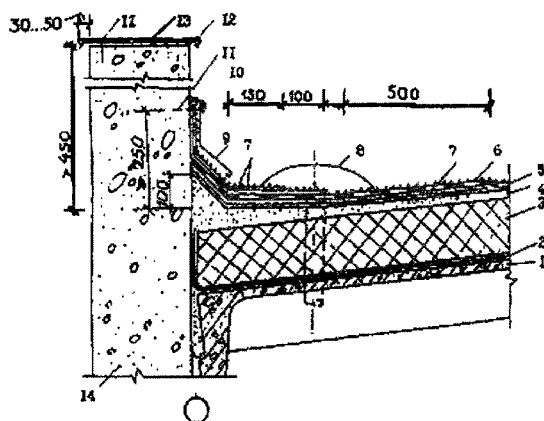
Примыкание кровли к парапету высотой более 450 мм
